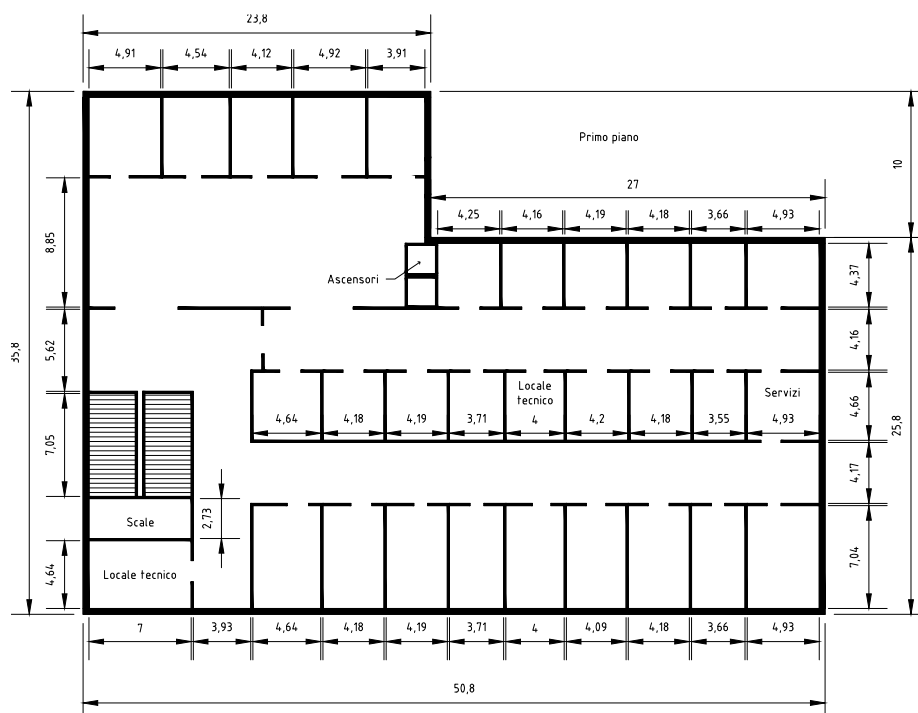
Planimetria del primo piano e dei successivi (1-4).
